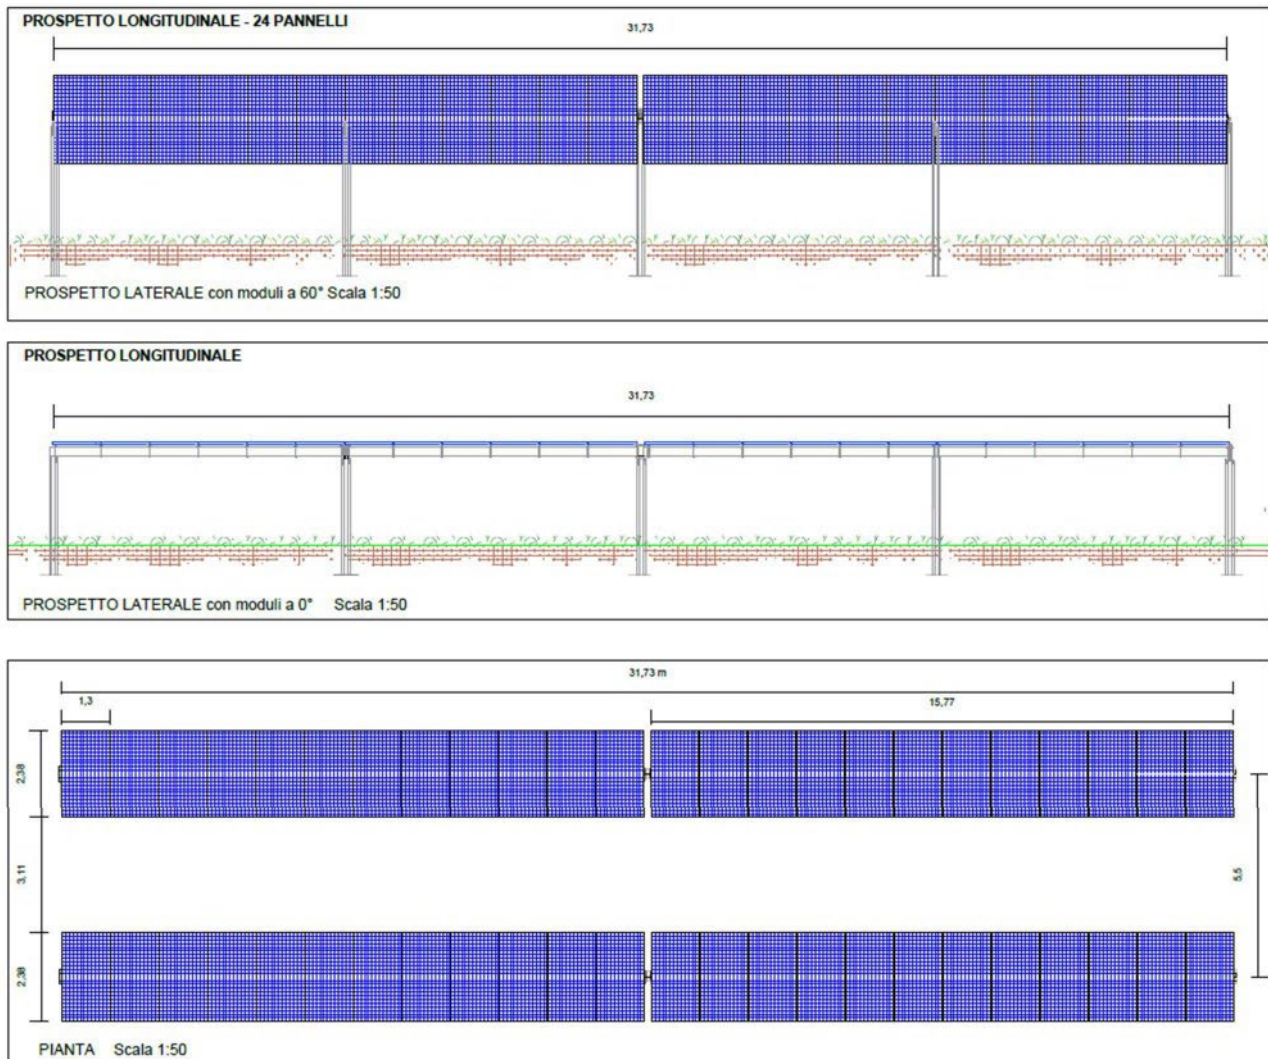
Strutture di sostegno in pianta 24 moduli
